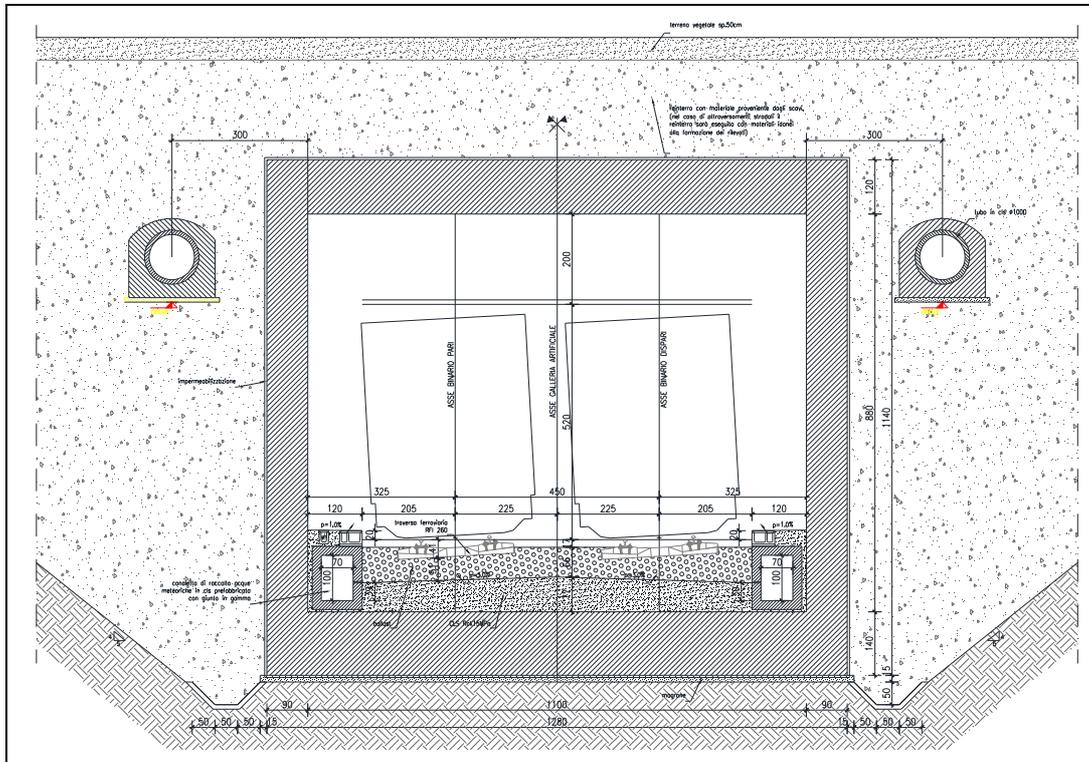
Sezione galleria artificiale nella zona in scavo con sistema cut & cover
